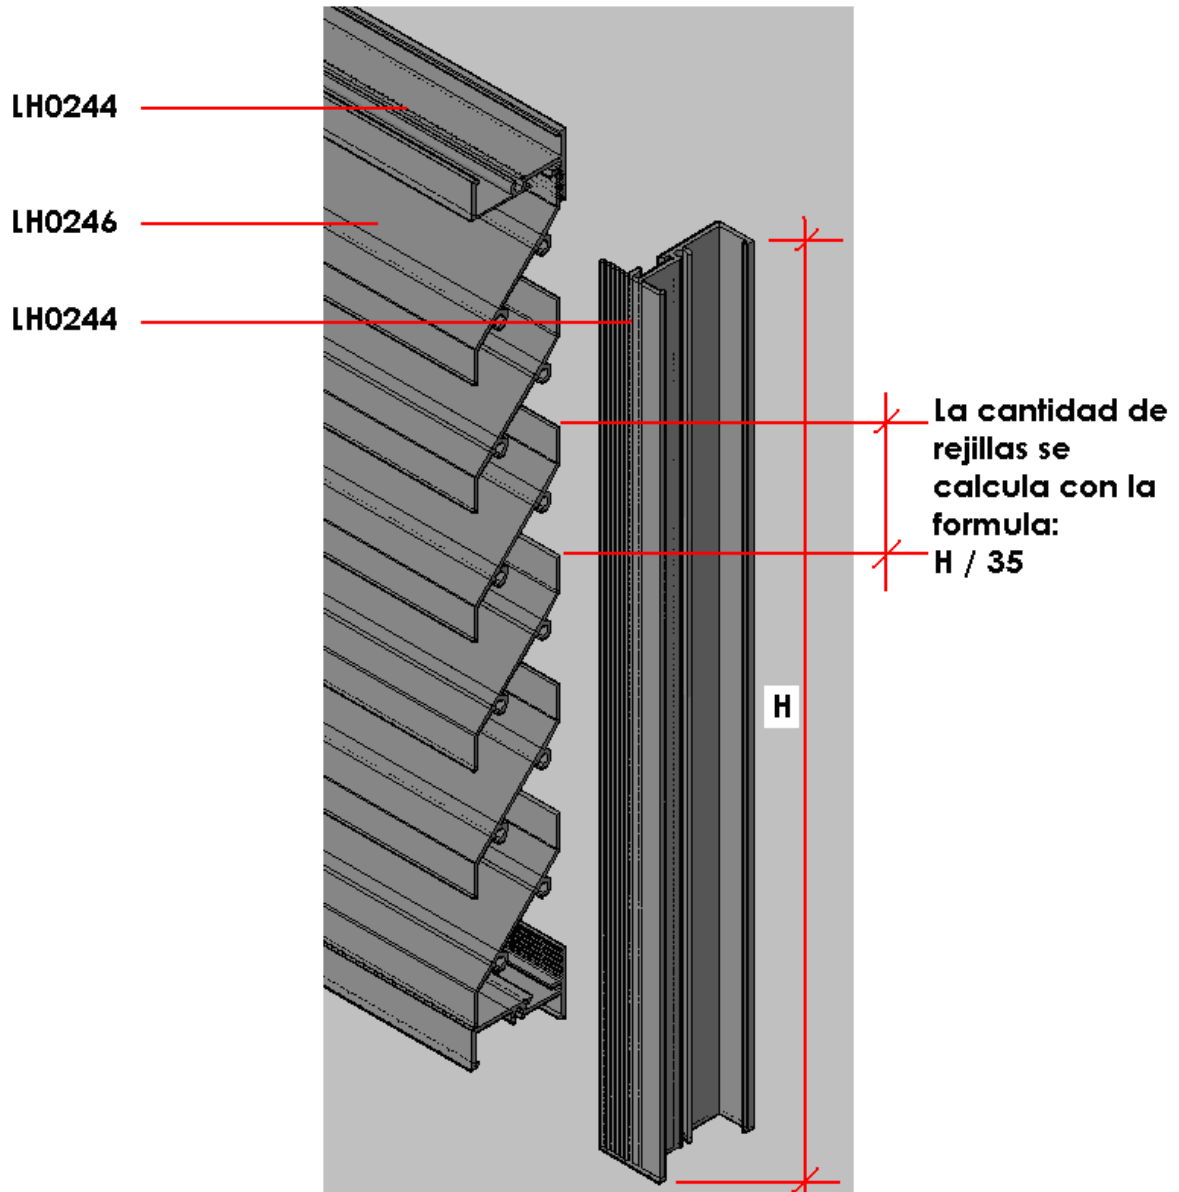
Detalle de instalación de perfilera en aplicación perimetral.
